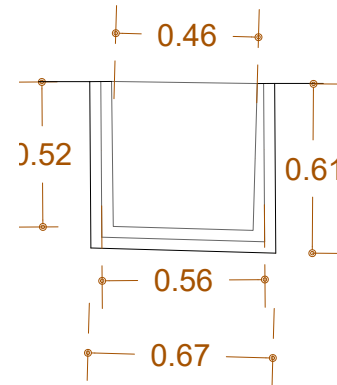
Pilastra Sur de Sotocoro Vista Frontal
